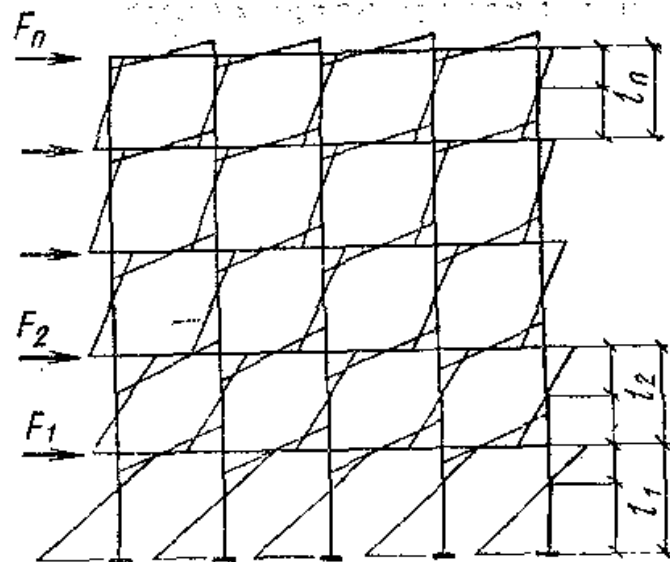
К расчёту многоэтажных рам на горизонтальные нагрузки
